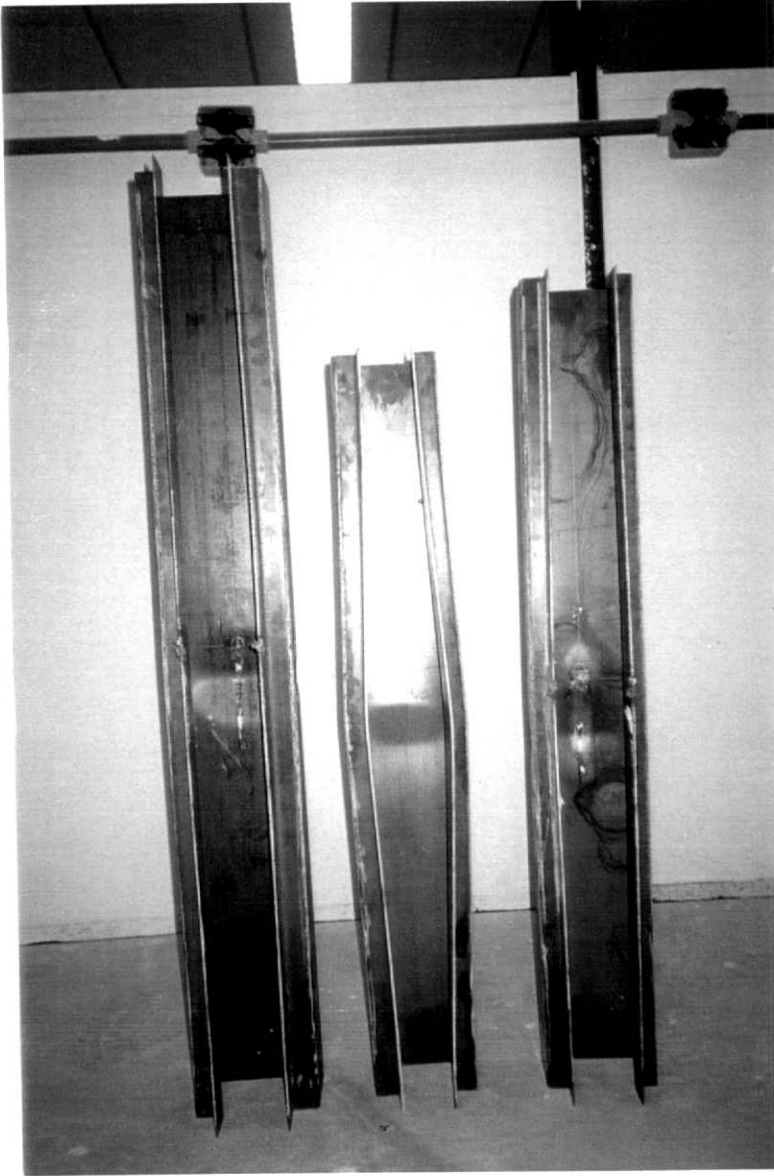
Mecanismo de colapso das três colunas com comprimento intermediário.
